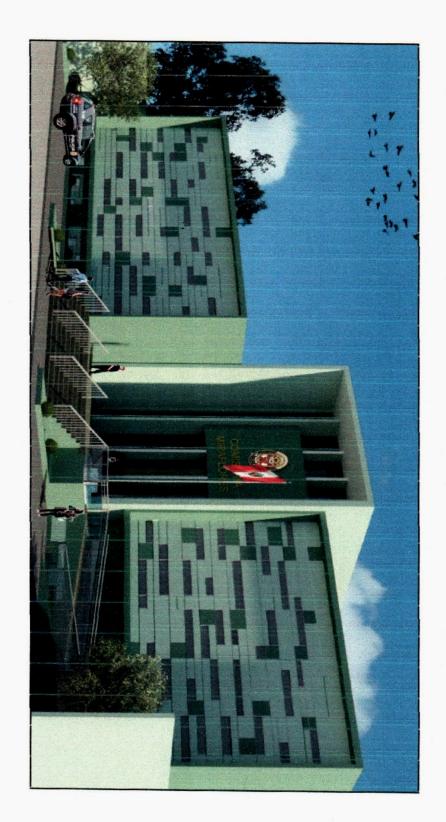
VISTA LATERAL DERECHA FACHADA PRINCIPAL DE COMISARÍA
